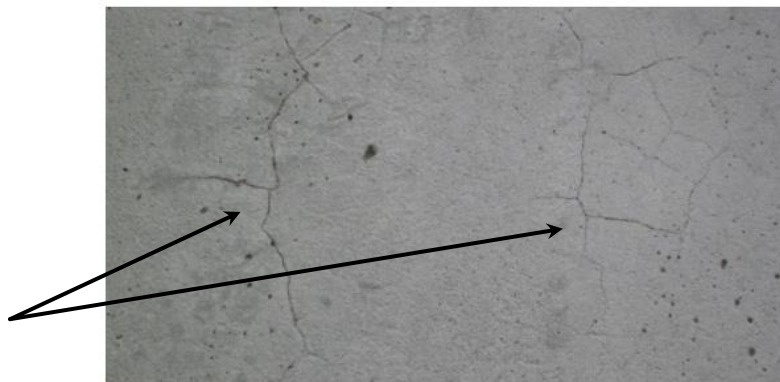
Fissures aléatoires précoces apparues dans une dalle de plancher en béton [43].
